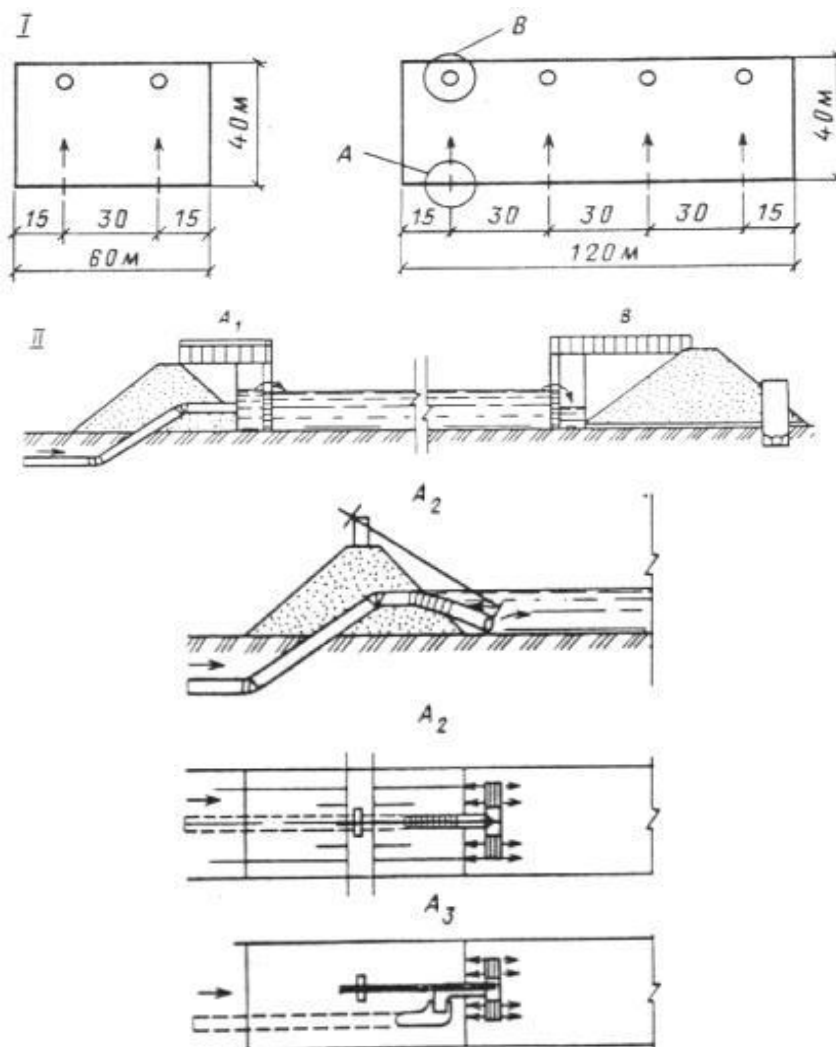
Площадки для обезвоживания осадка по [44]:
